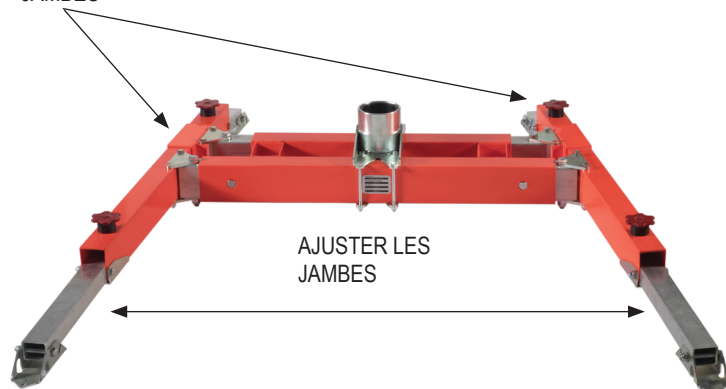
, assemblage et ajustage de Jackpod Base Portable
